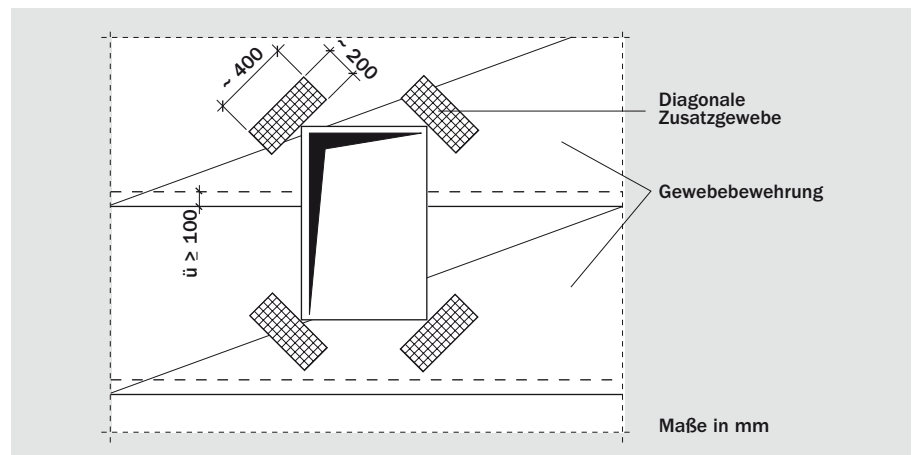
Erforderliche Überlappung der Glasgewebebewehrung sowie diagonale Zusatzbewehrung im Eckbereich von Wandöffnungen
